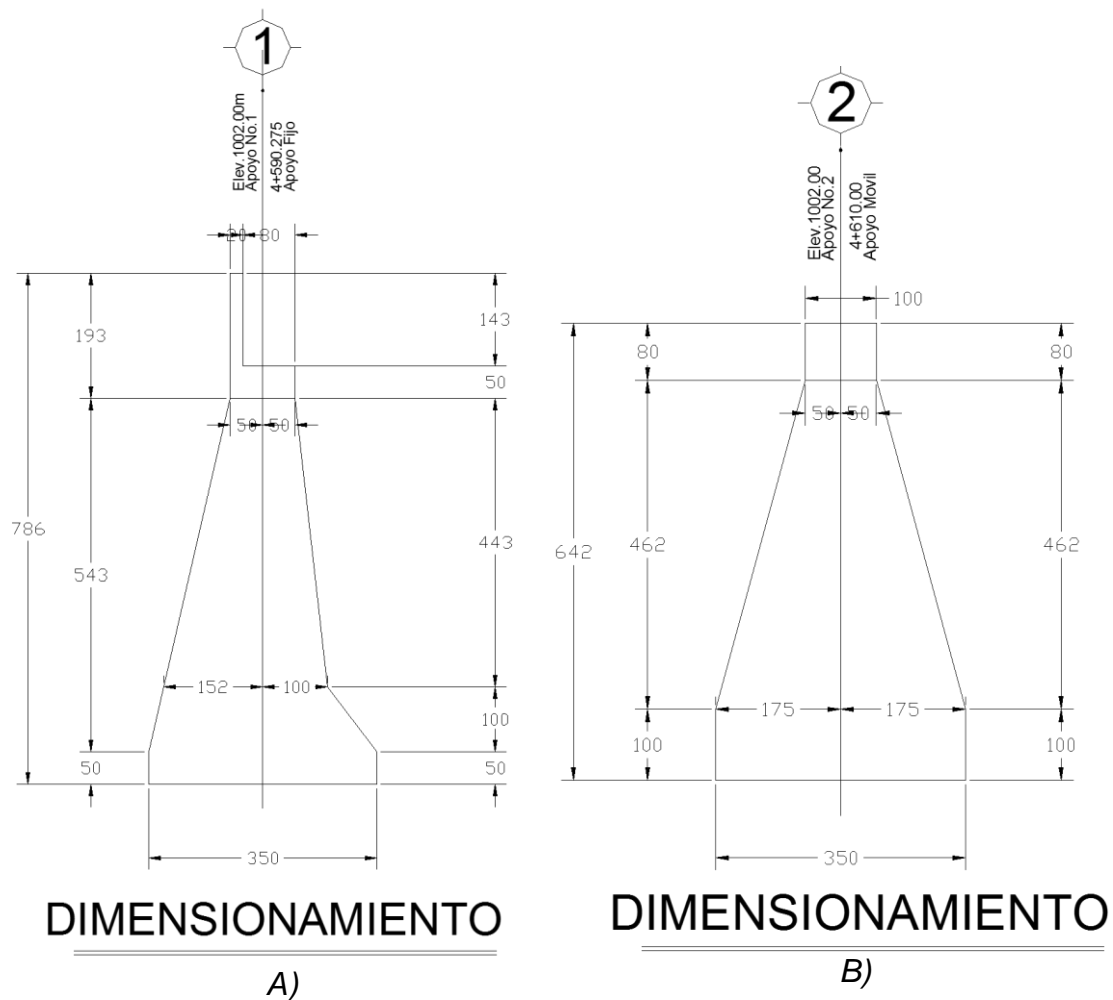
Detalles de las pilas y estribos del puente Paso de la virgen. A) Detalle del estribo; B) Detalle de la pila.
